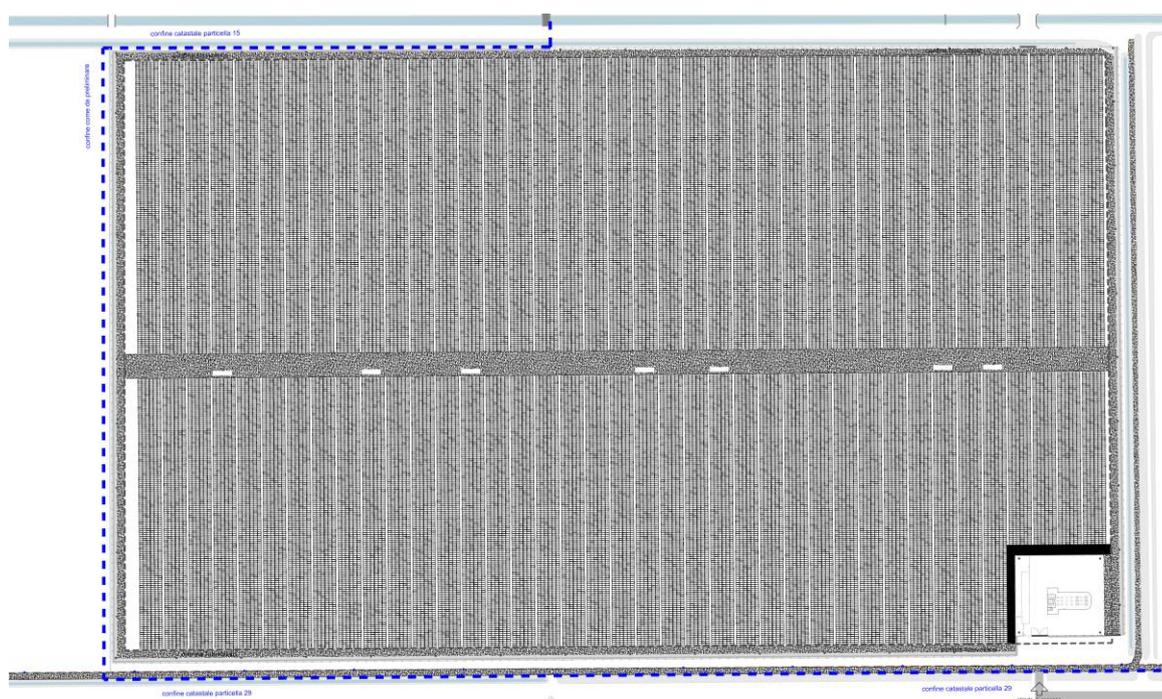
Estratto della tavola di progetto dell'impianto fotovoltaico Leona Sud. Disposizione dei pannelli e delle cabine nella parte Sud del sito.
